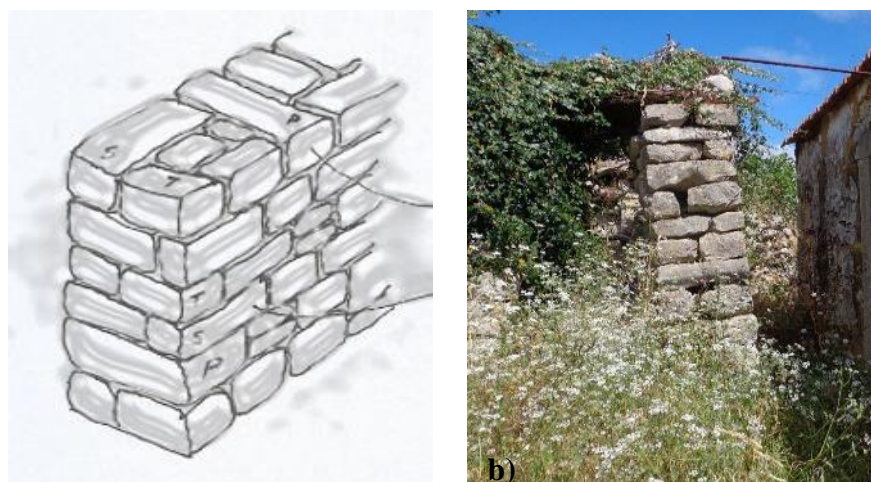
Muros de pedra seca: a) e b) Utilização de sogas, tições e perpianhos em muros
